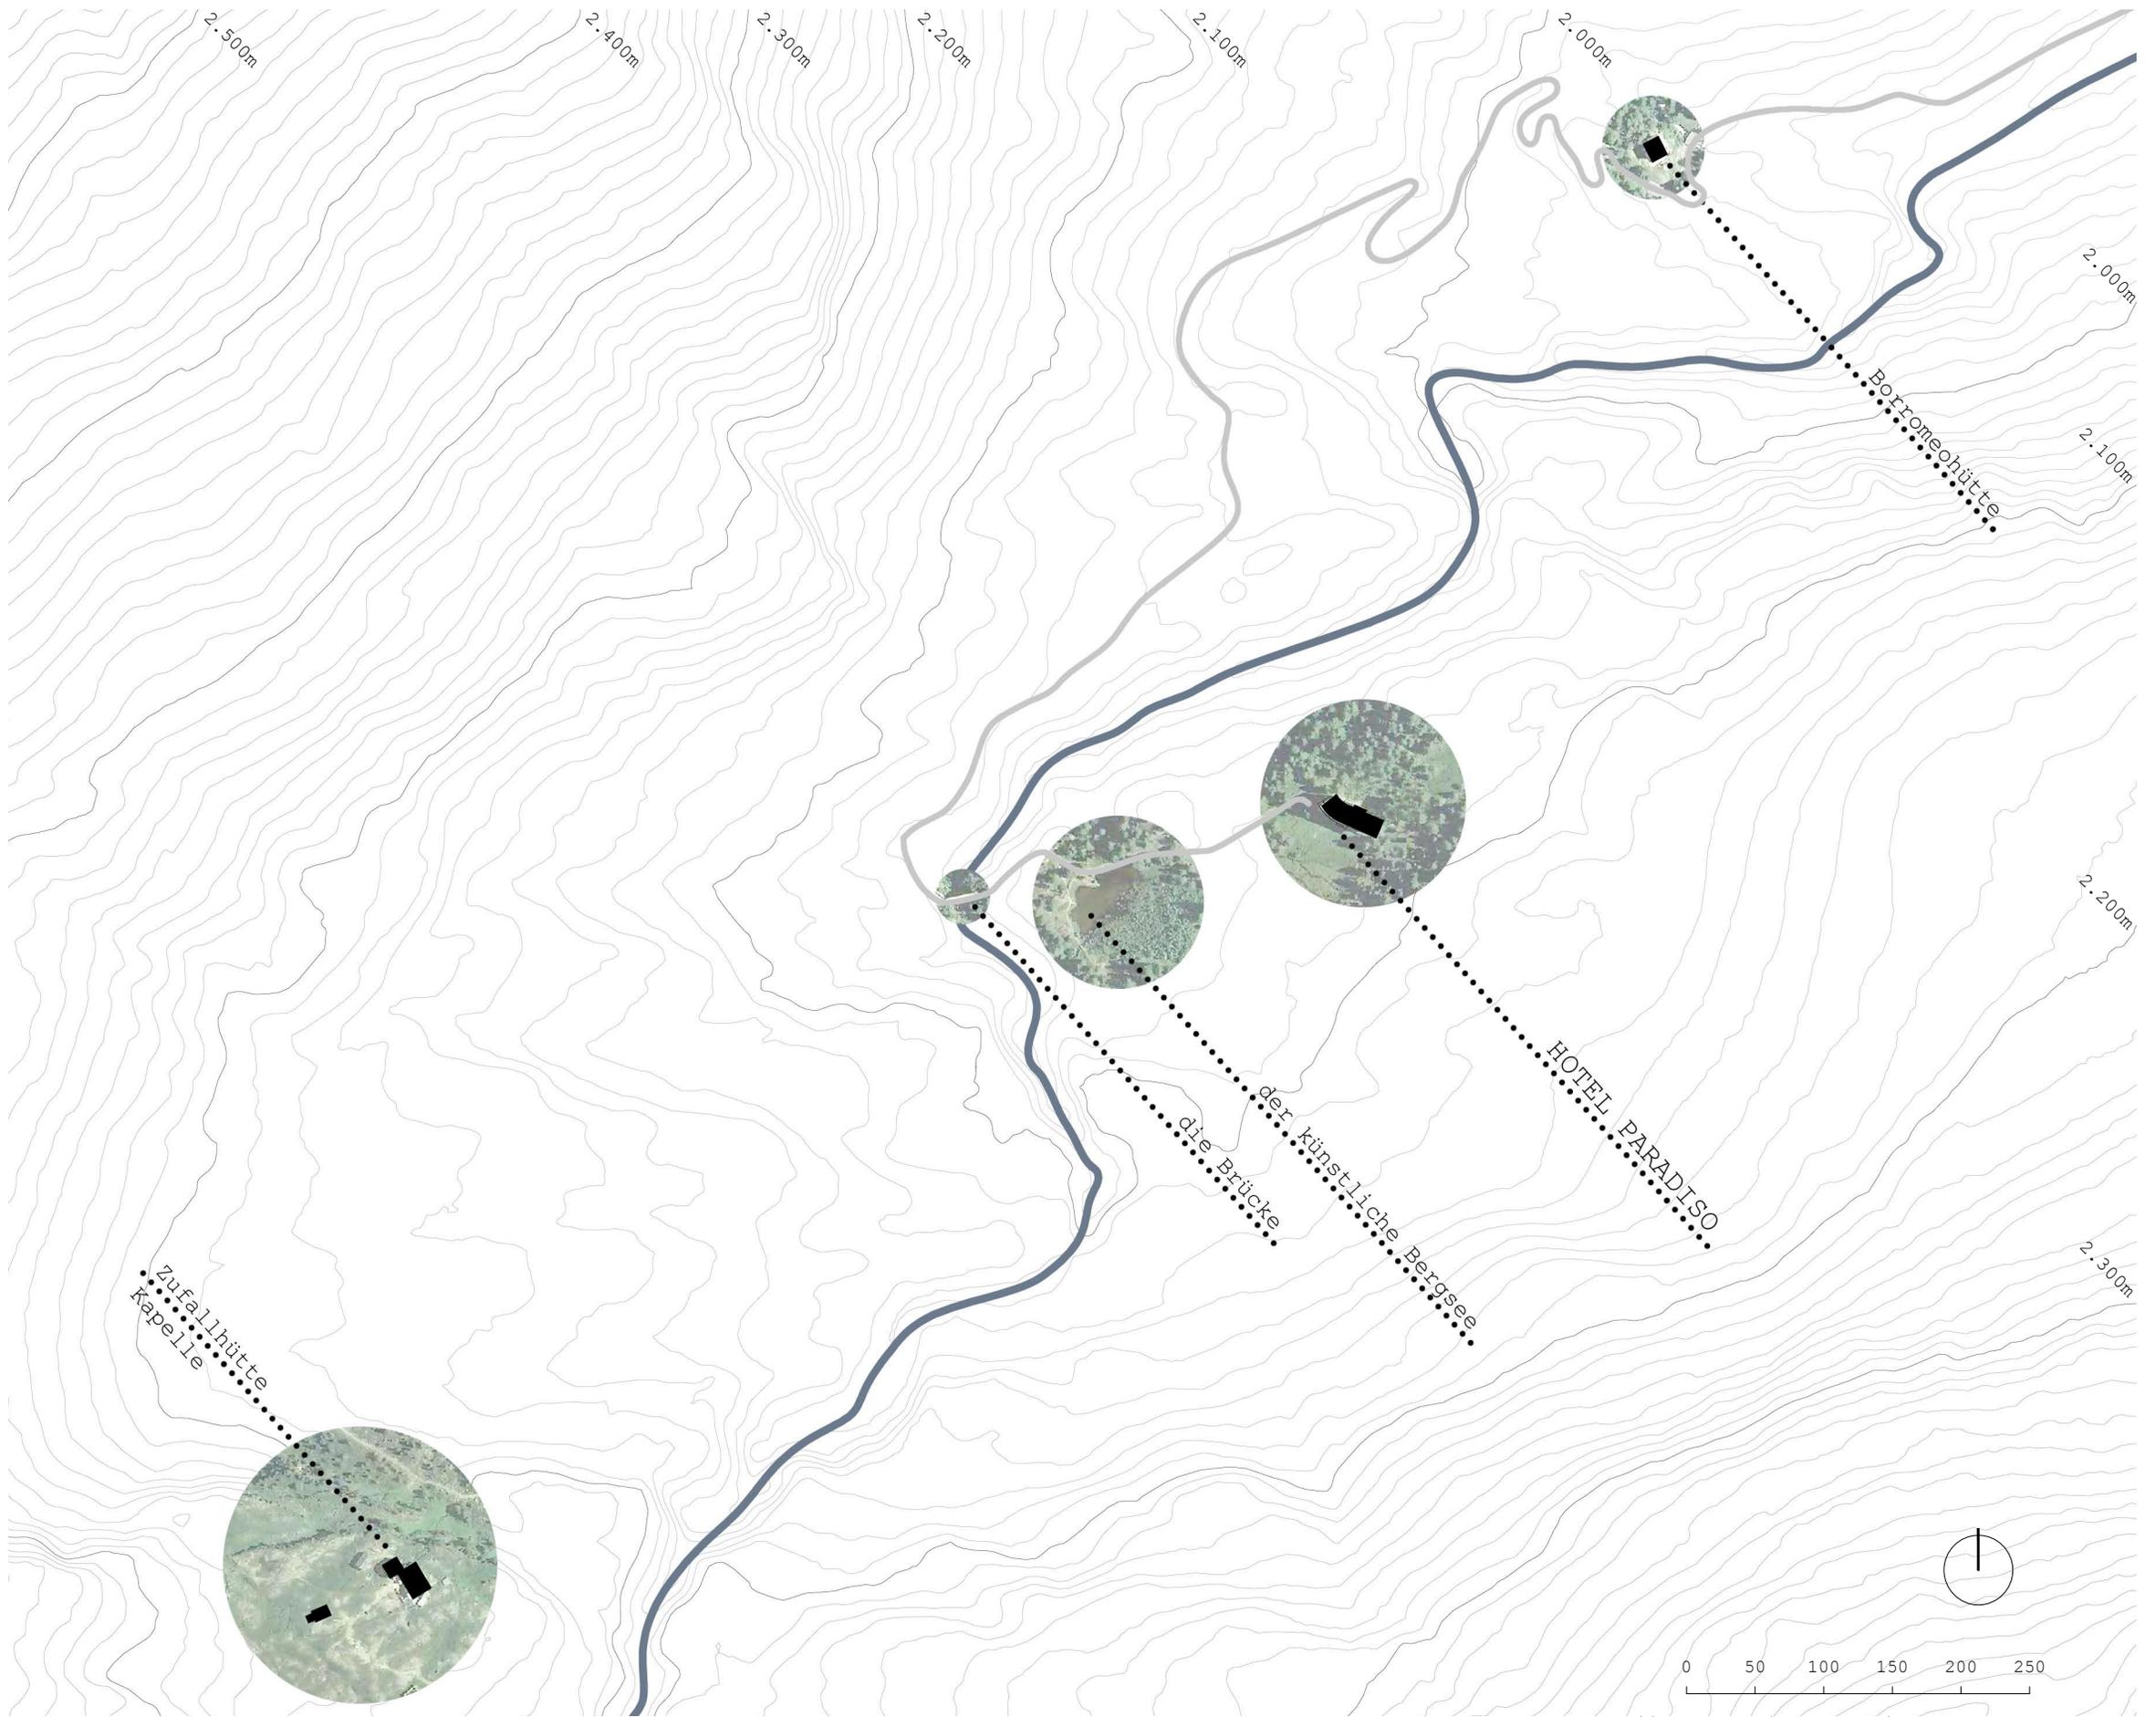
Lageplan mit Umgebung 1938_1:5000
